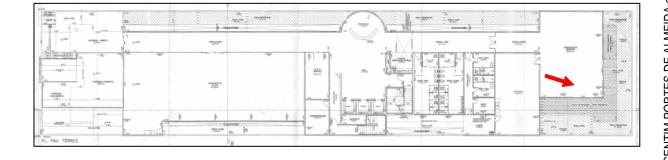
Fundos do pavimento térreo. Destaque para o poço de iluminação dos subsolos.
